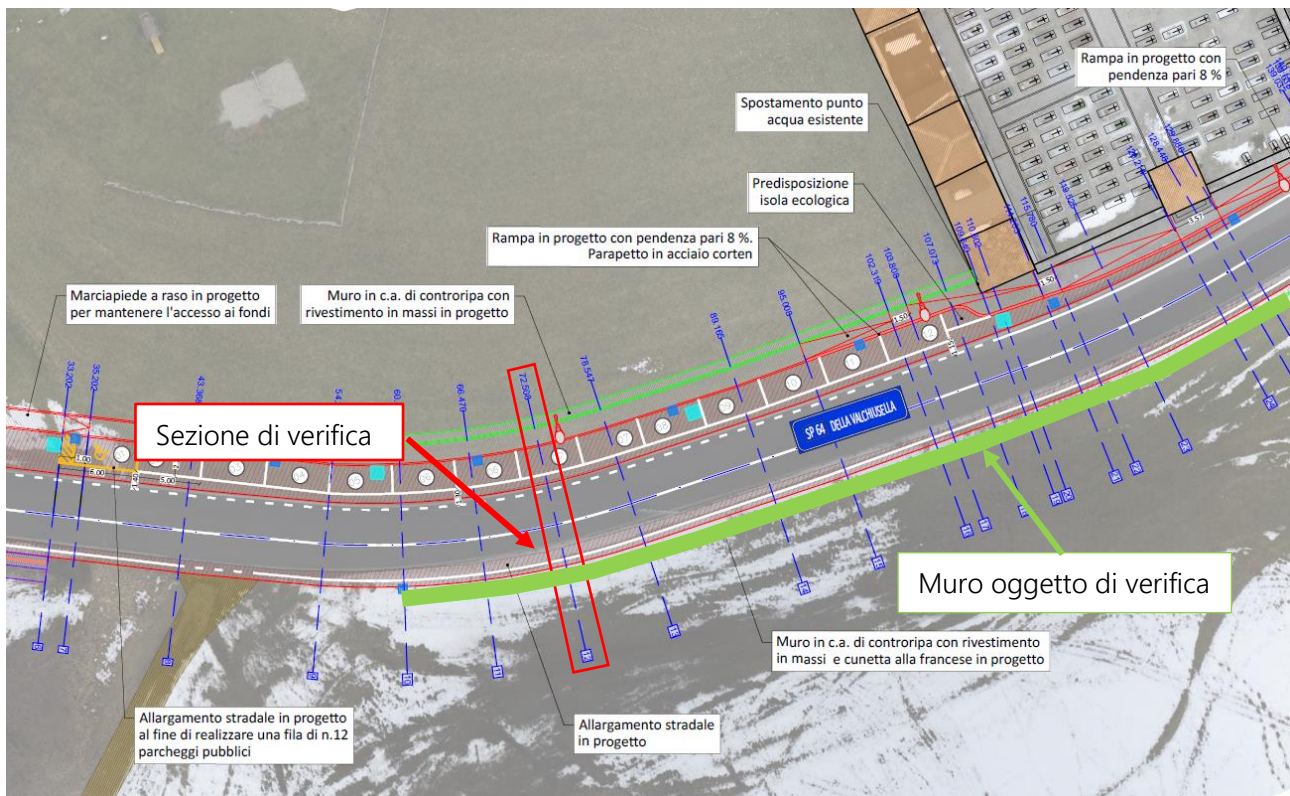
Planimetria progetto_ In rosso sezione di verifica
